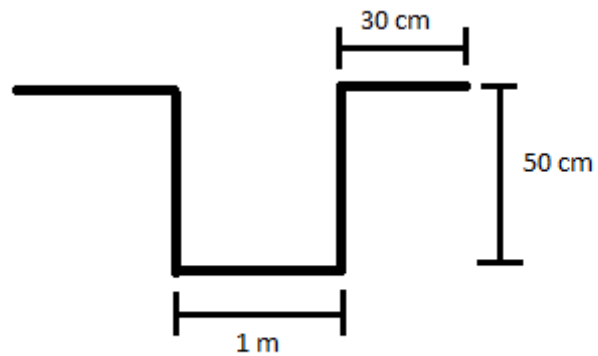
zanja drenaje. Fuente: Autor del proyecto
